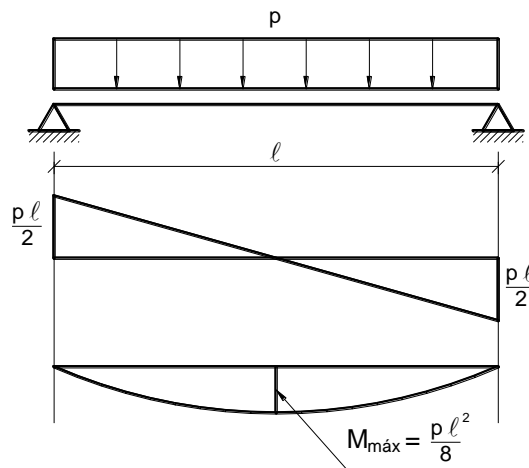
Laje armada em uma direção sobre apoios simples e com carregamento uniforme.
